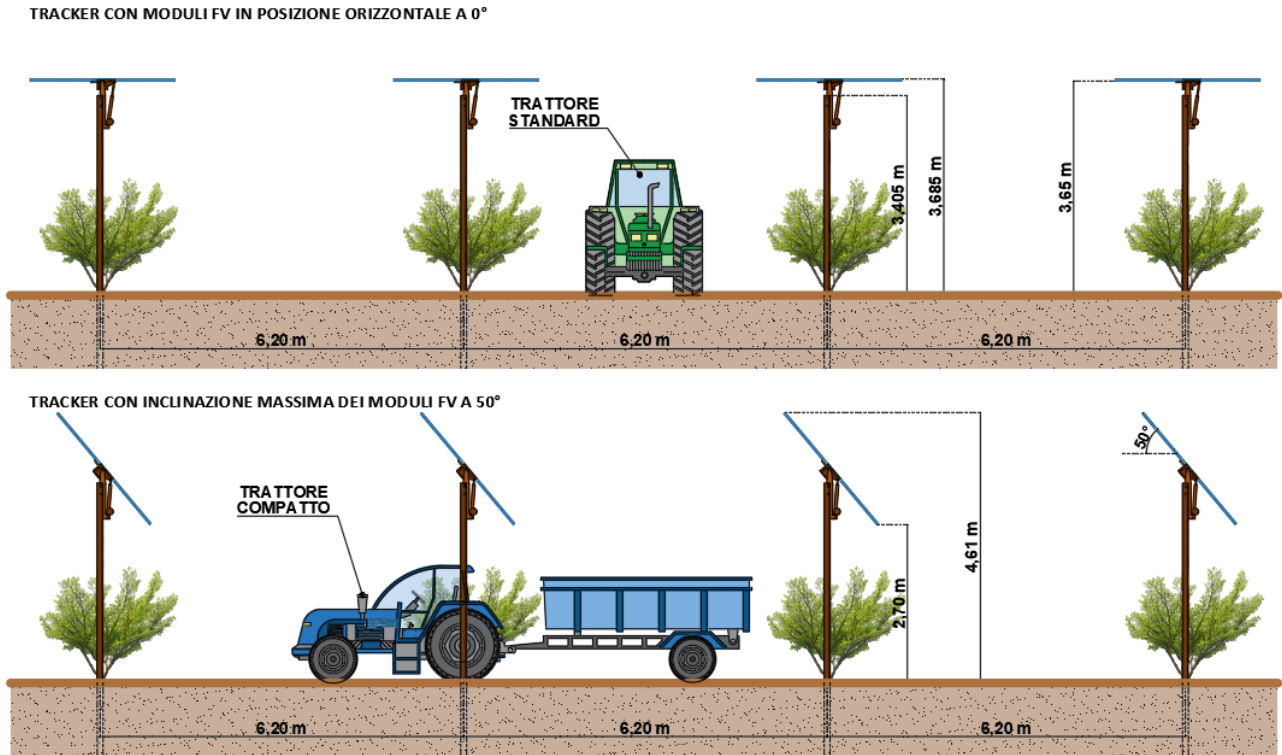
Particolare disposizione moduli su tracker: evidenza altezze dal suolo
